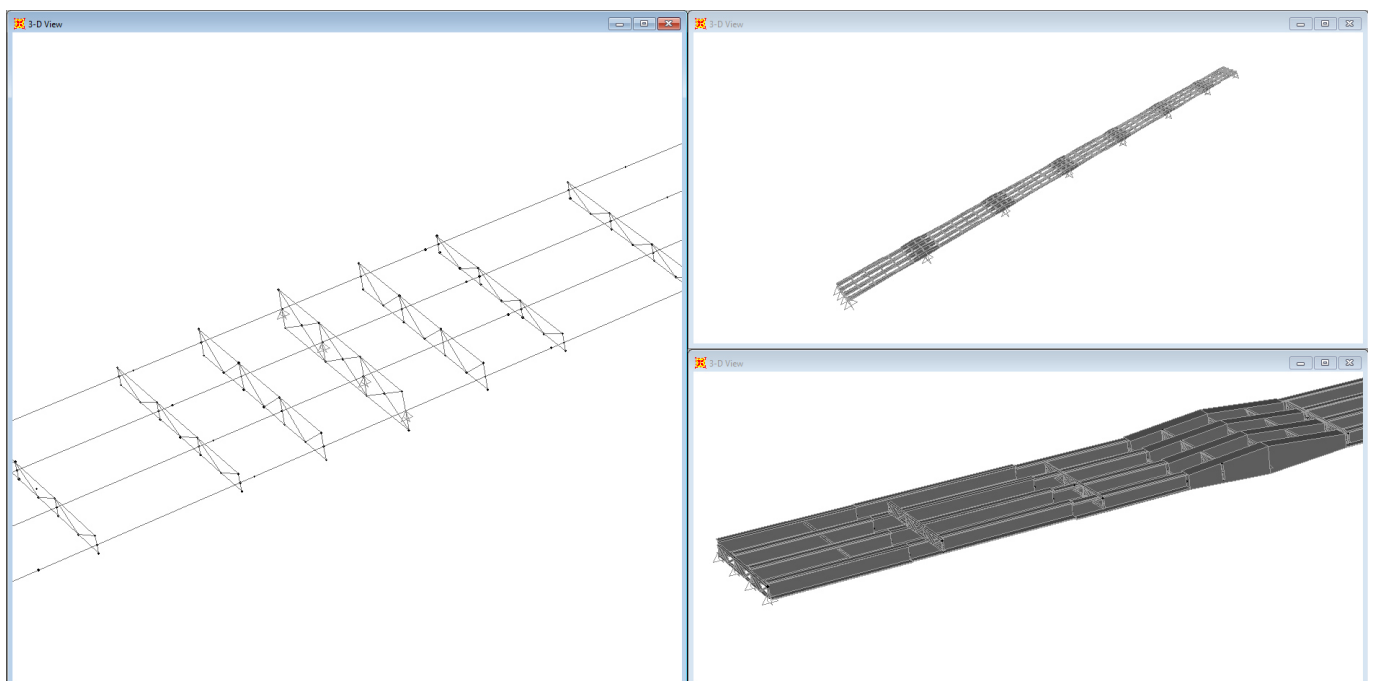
SCHEMA DEL MODELLO FEM – FASE 1 – SEZIONE SOLO ACCIAIO
